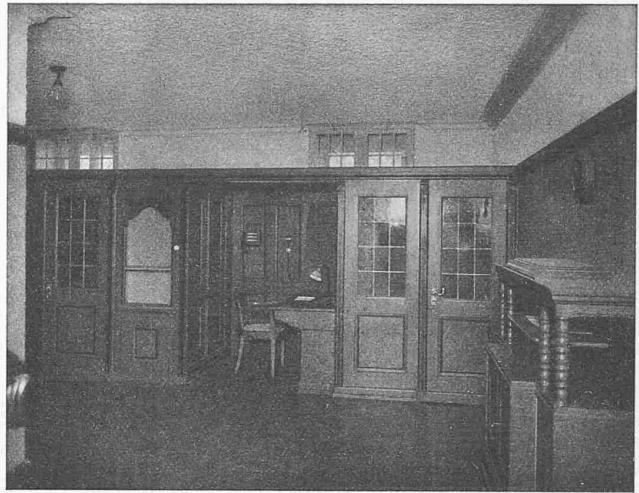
Kabinen im Safe-Vorraum (vergl. Grundriss Abb. 13).
